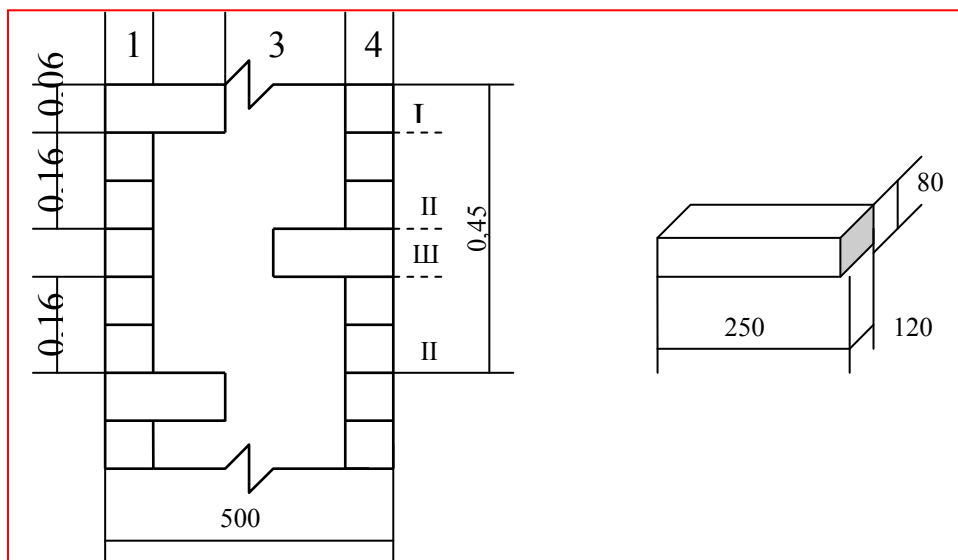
Расчетное поперечное сечение конструкции стены
